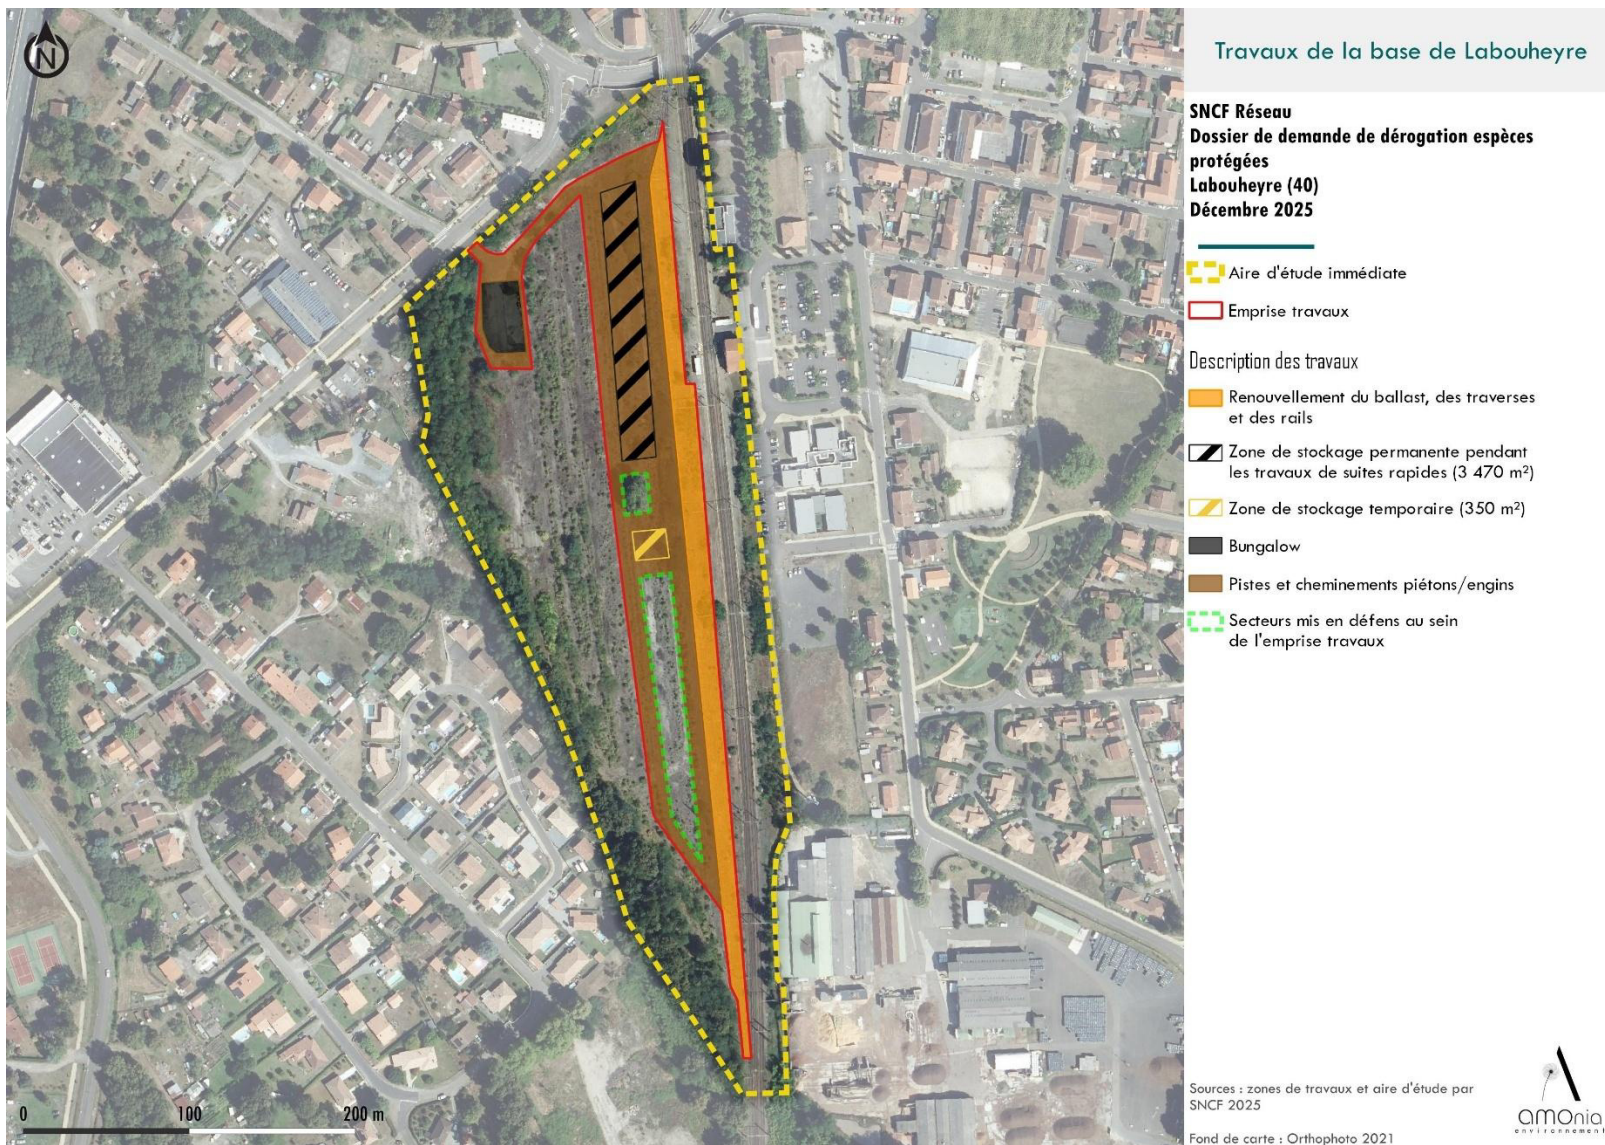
Plan des travaux préparatoires de la base de Labouheyre
